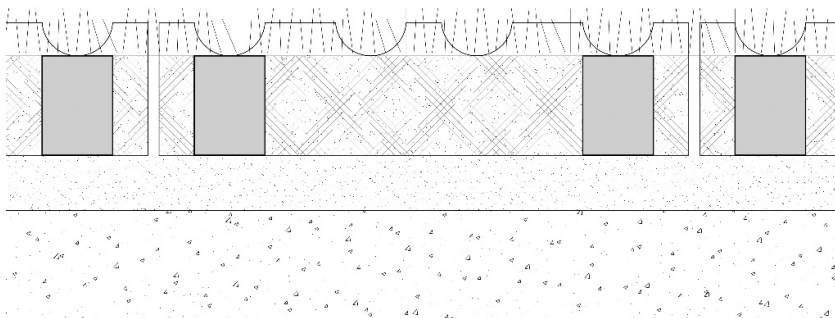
, pavimento estacionamiento, de abajo hacia arriba: tosca compactada, arena limpia nivelada 50mm, adoquín calado de hormigón greenblock, arena y tierra sembrada 50-50 hasta el ras del adoquín.
